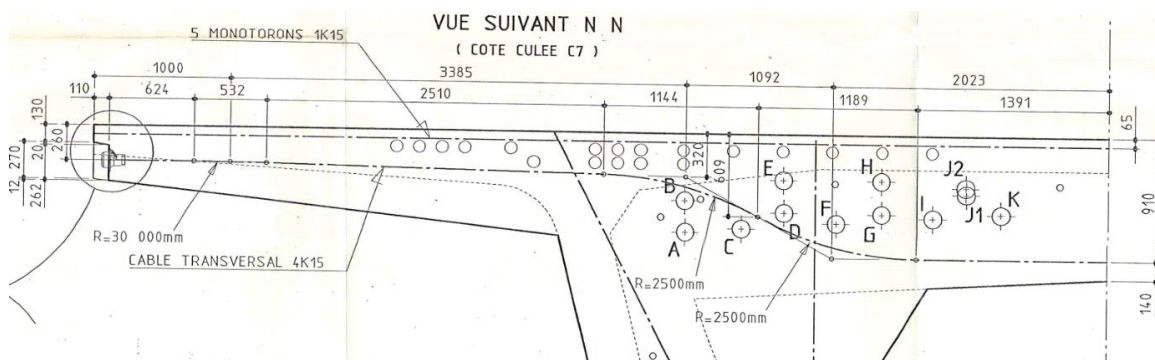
Précontrainte transversale sur pile : coupe transversale (extrait plan P432)
